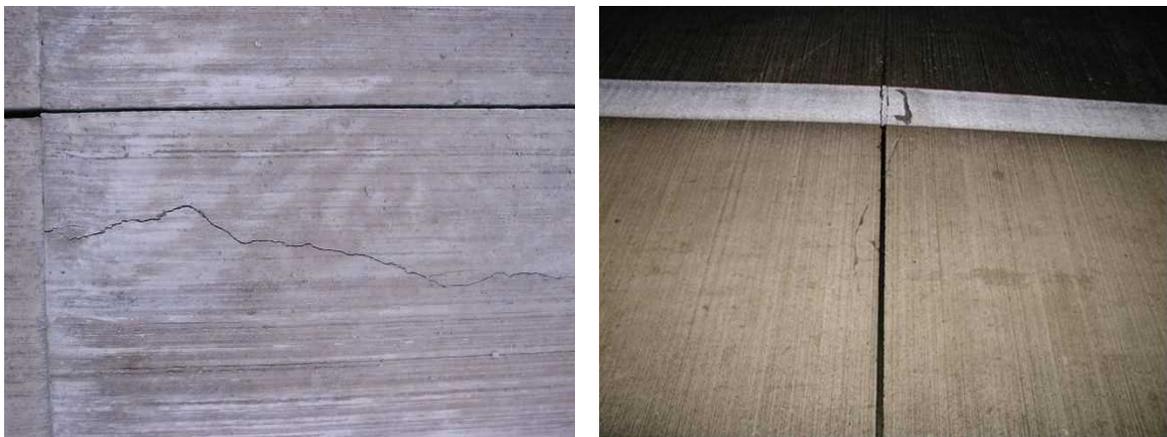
ダウエルバーの移動によるものと思われるひび割れ
